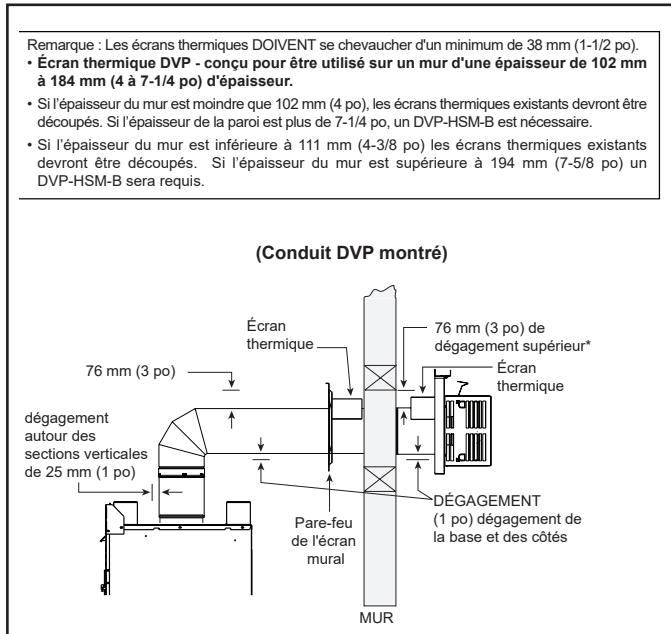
Dégagements des conduits horizontaux avec les matériaux inflammables
